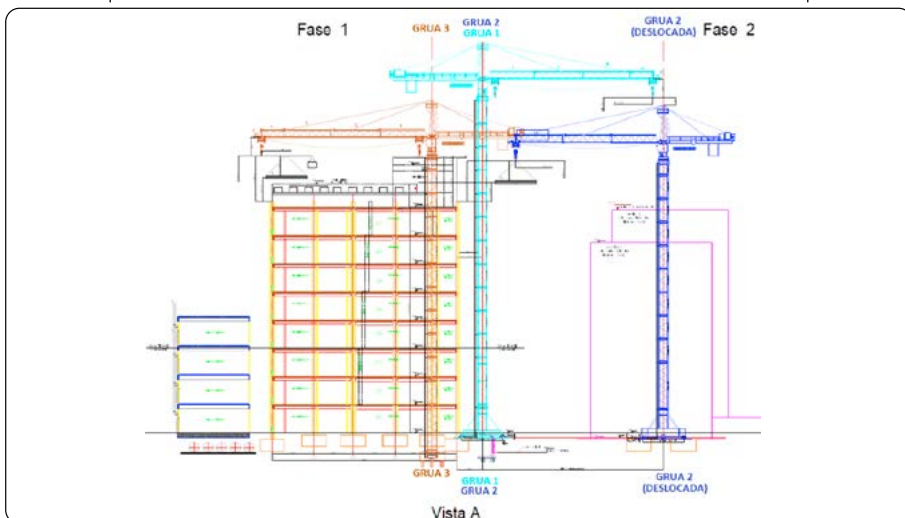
Seleção e localização dos guindastes no canteiro de obras, Empresa A (2025).
